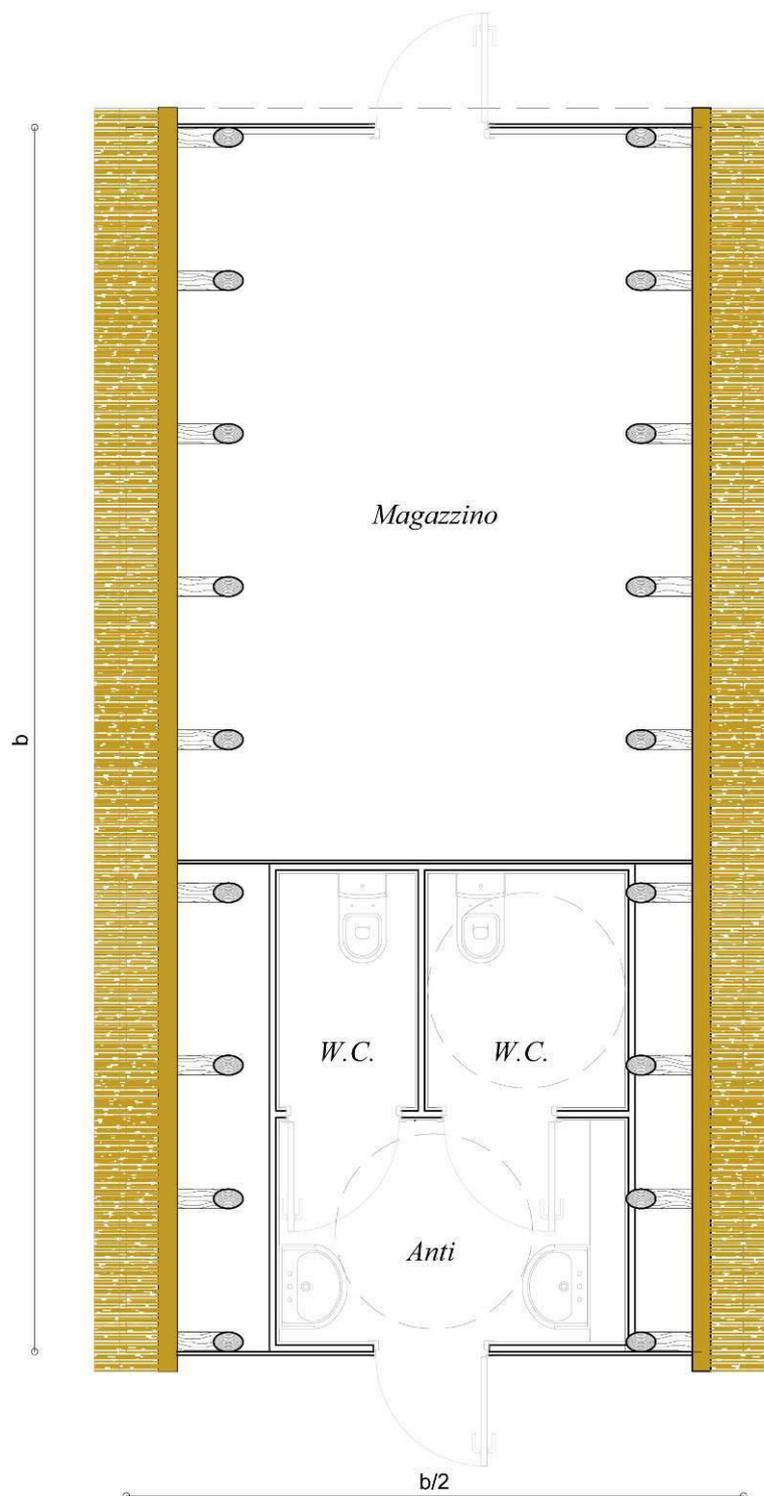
Casone secondario. Pianta (suddivisione interna non prescrittiva).
